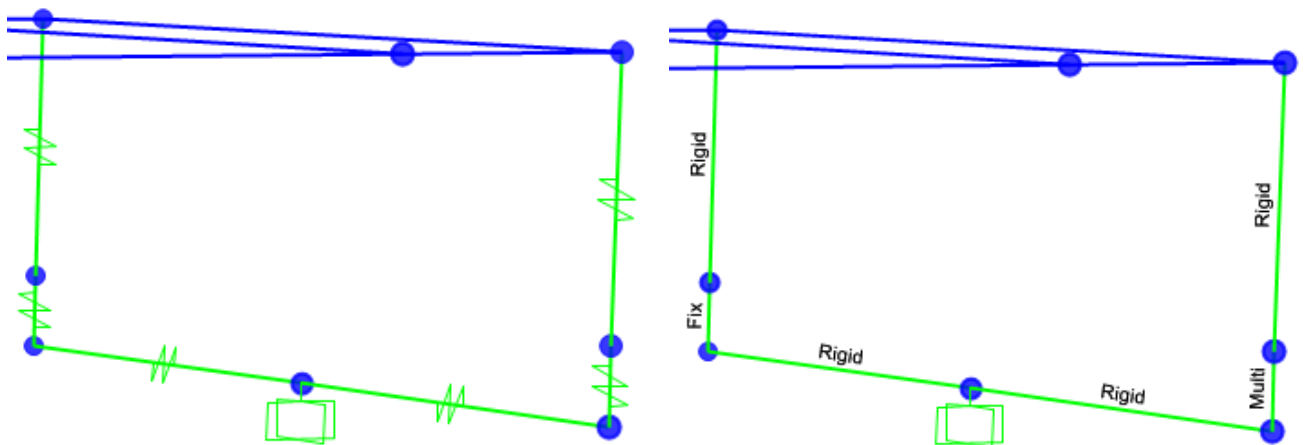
Modellazione connessioni tra travi e appoggi su spalla "SP2" lato Rotonda 2
